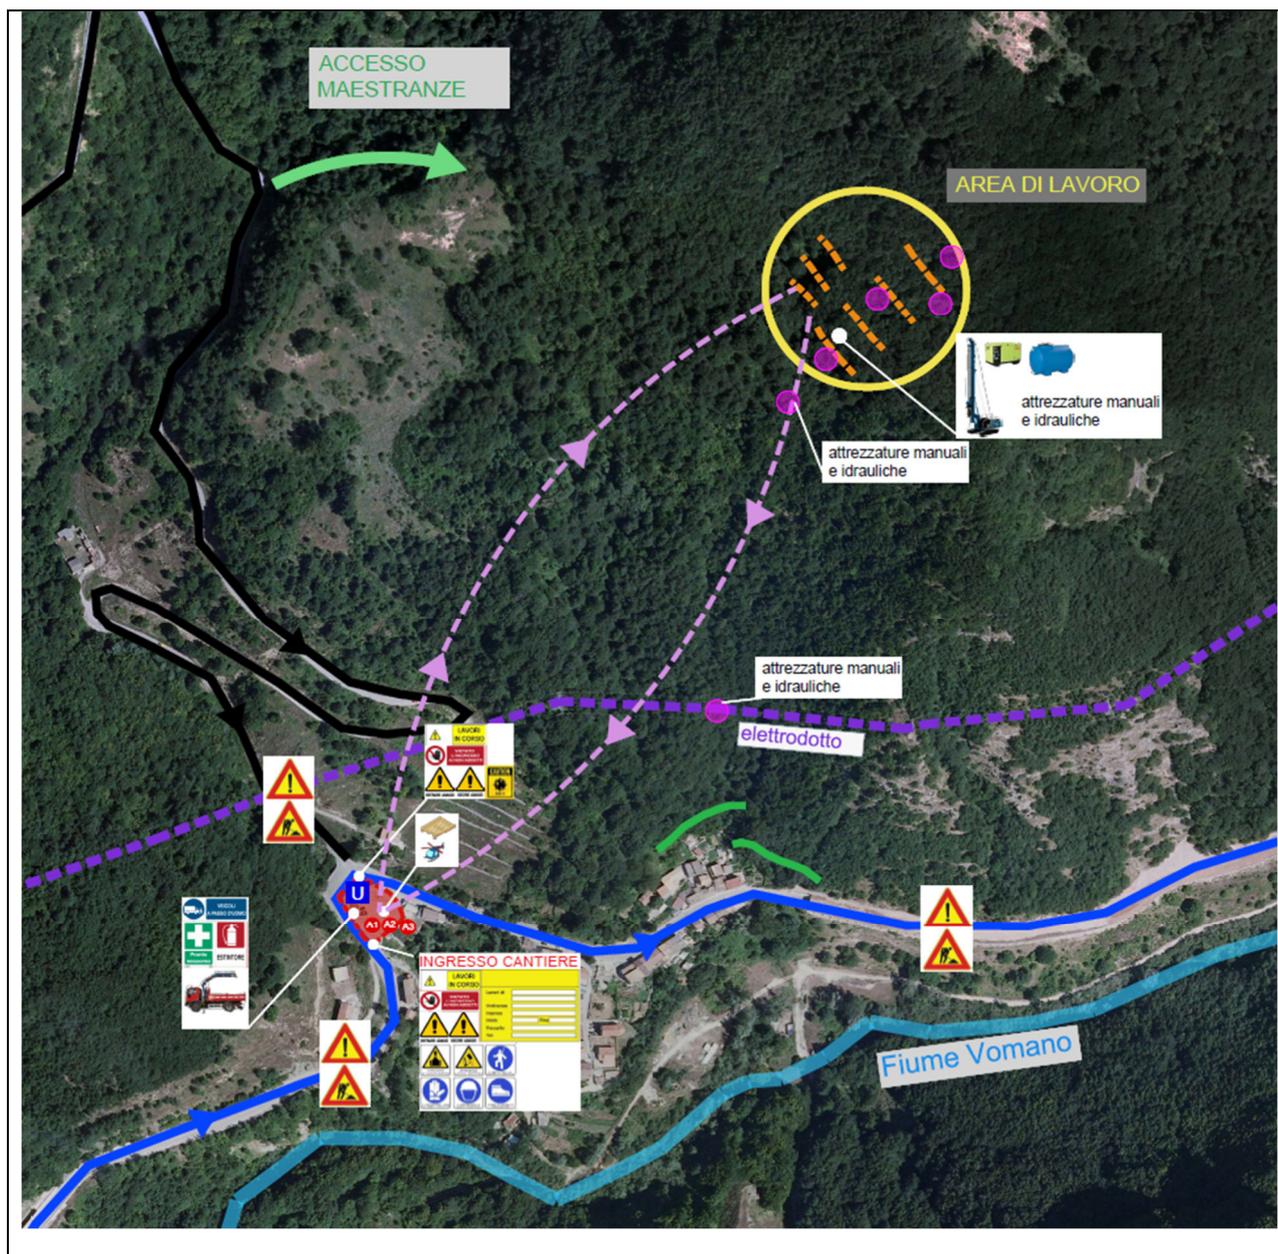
Cantierizzazione (estratto dall'Elaborato E5)
